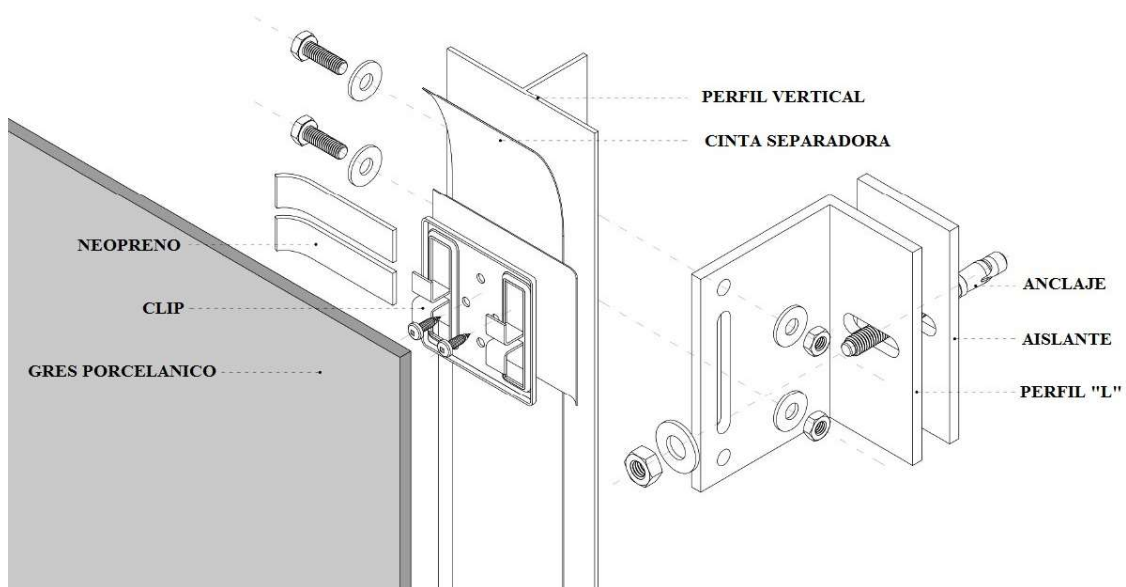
Sistema anclaje y subestructura, (Fuente: LaminaM)
